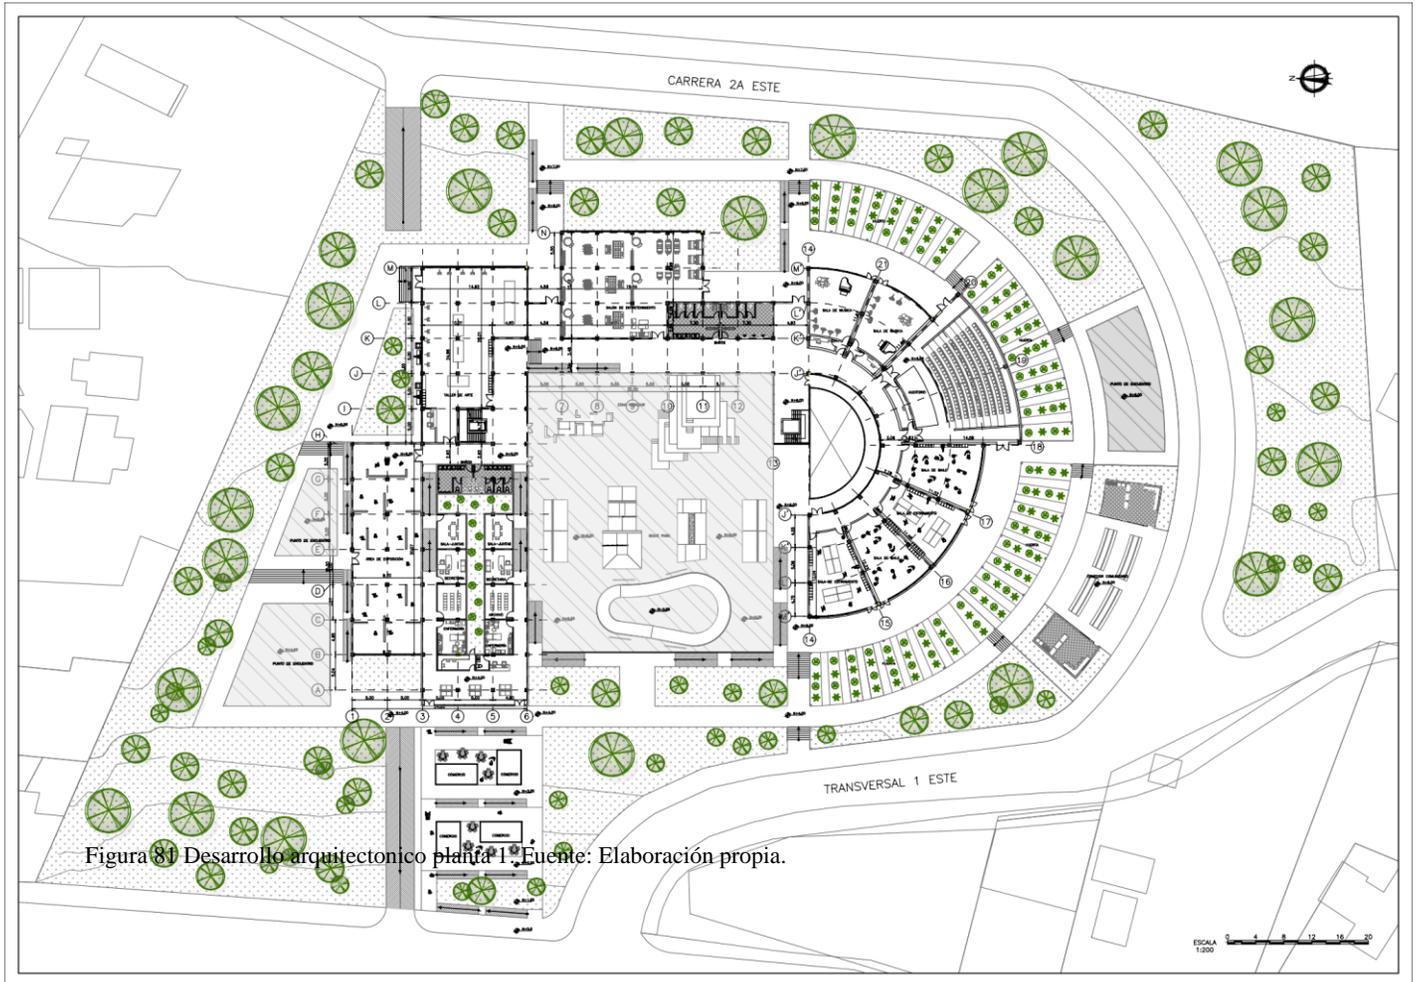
Desarrollo arquitectónico planta 1. Fuente: Elaboración propia.
